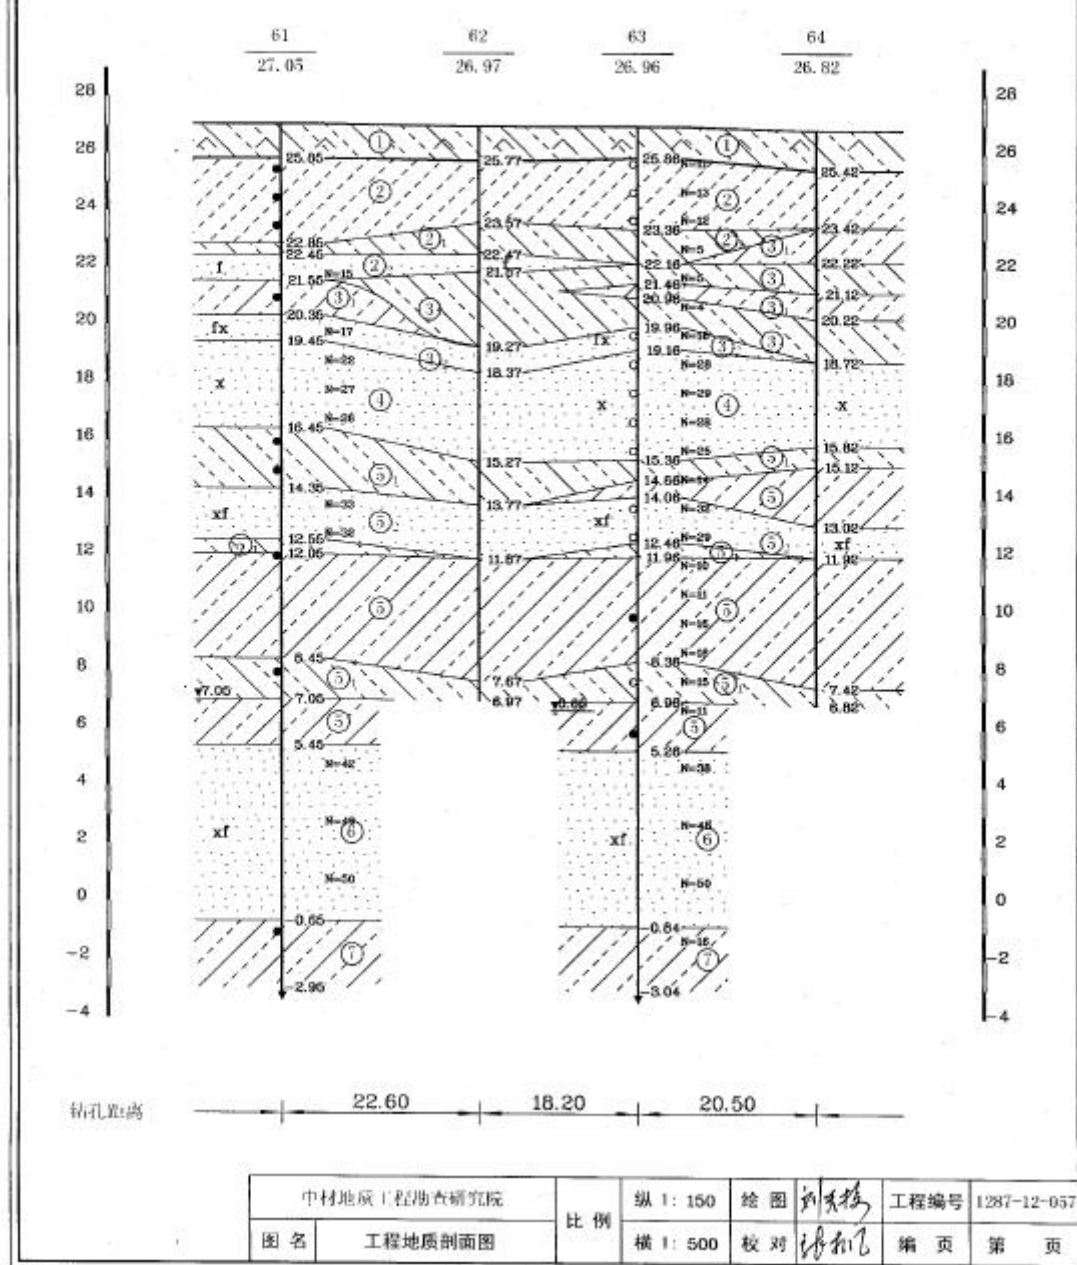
厂区地层钻孔剖面图 1-1'
